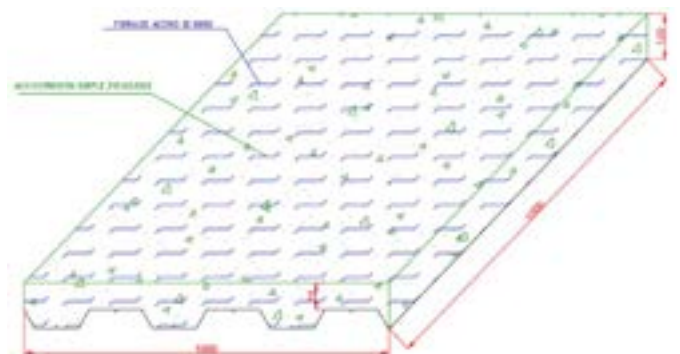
Rubro “Hormigón 210 con 15 fibra 80/60 en losa deck 7cm.”
